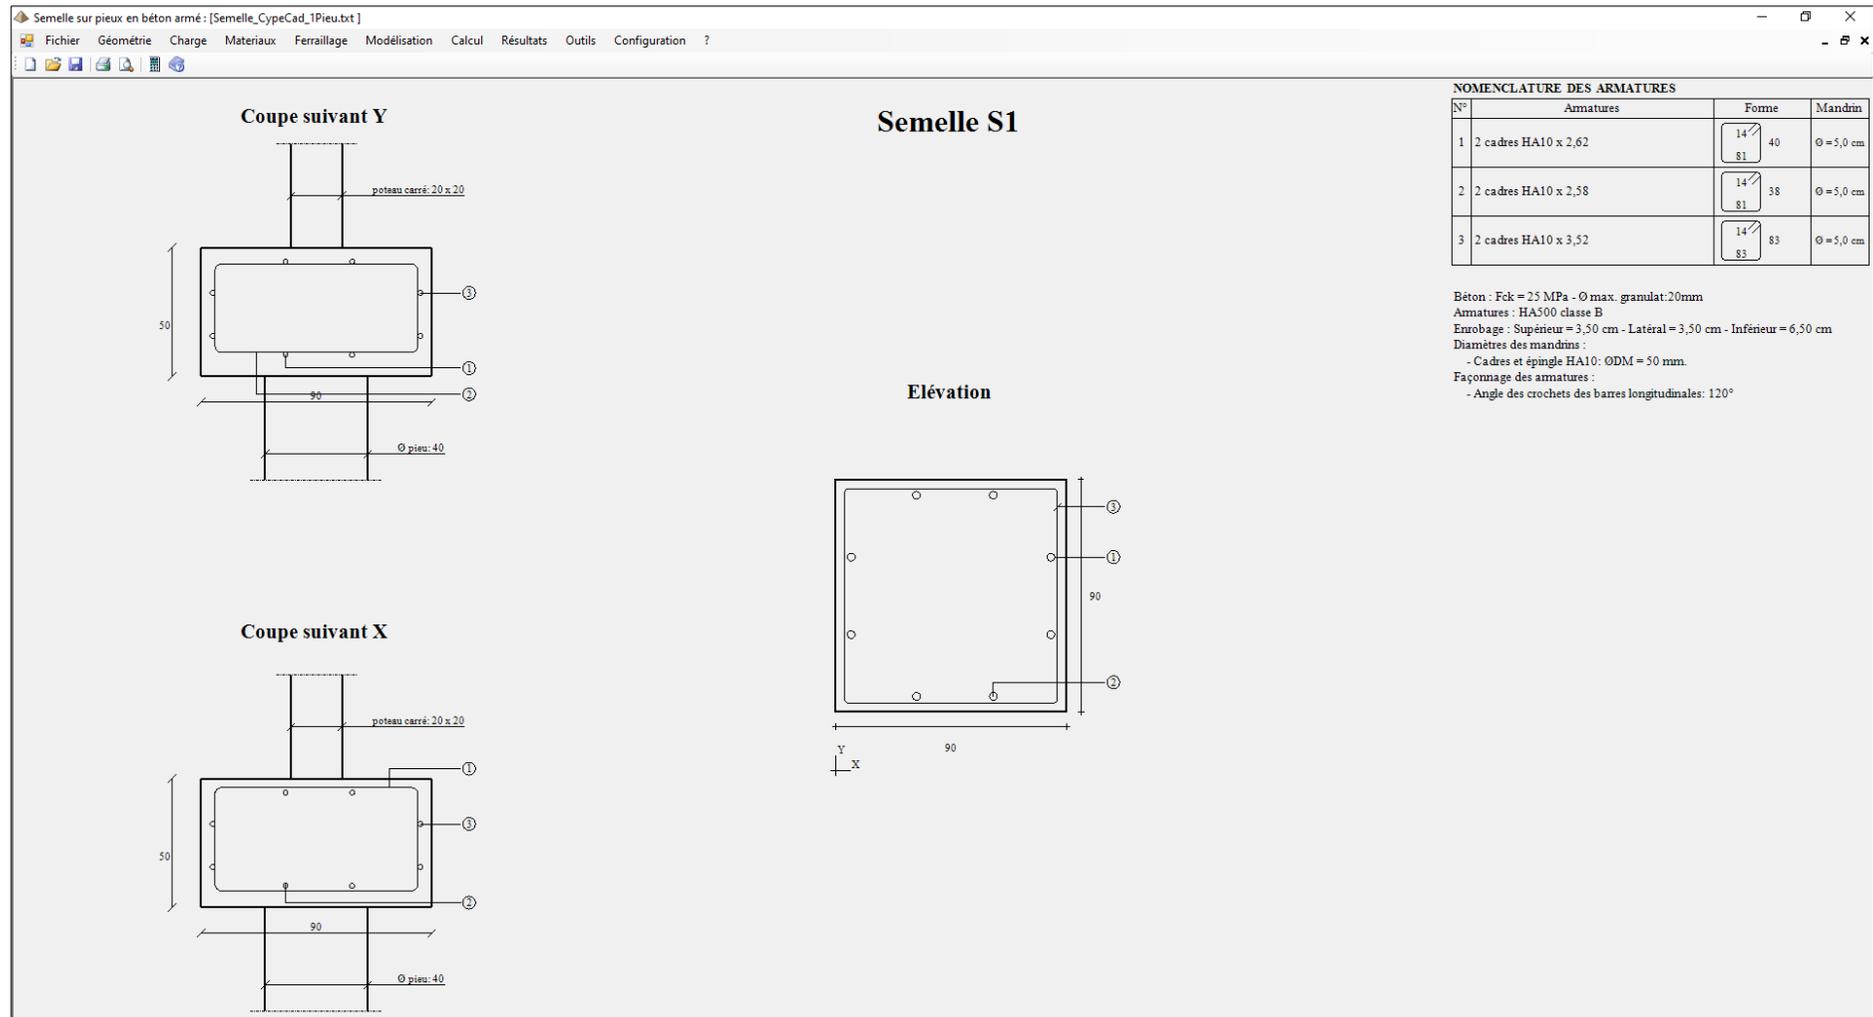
Ecran du plan de ferrailage sur un pieu
